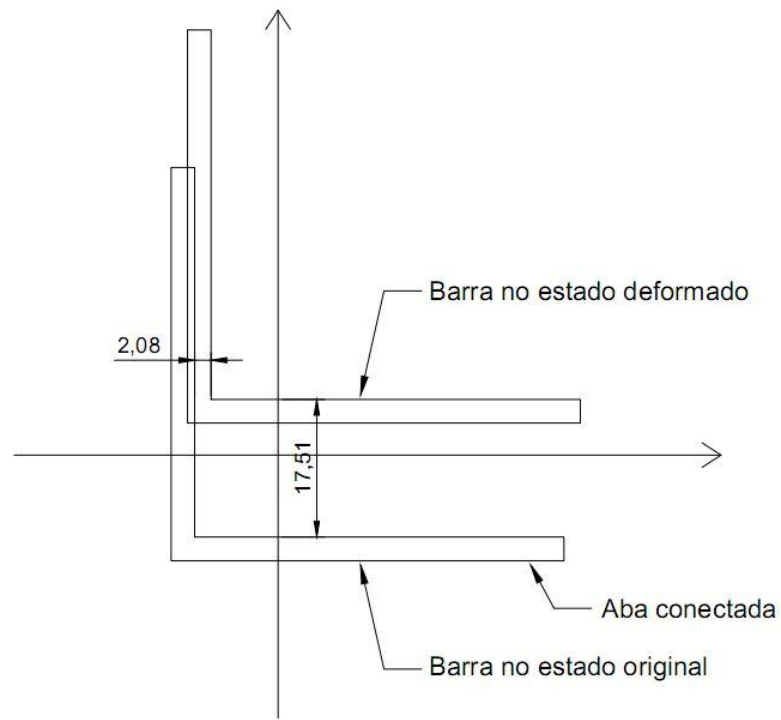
Cantoneira no estado original e estado deformado para esbelteza 110. Fonte: O autor.
